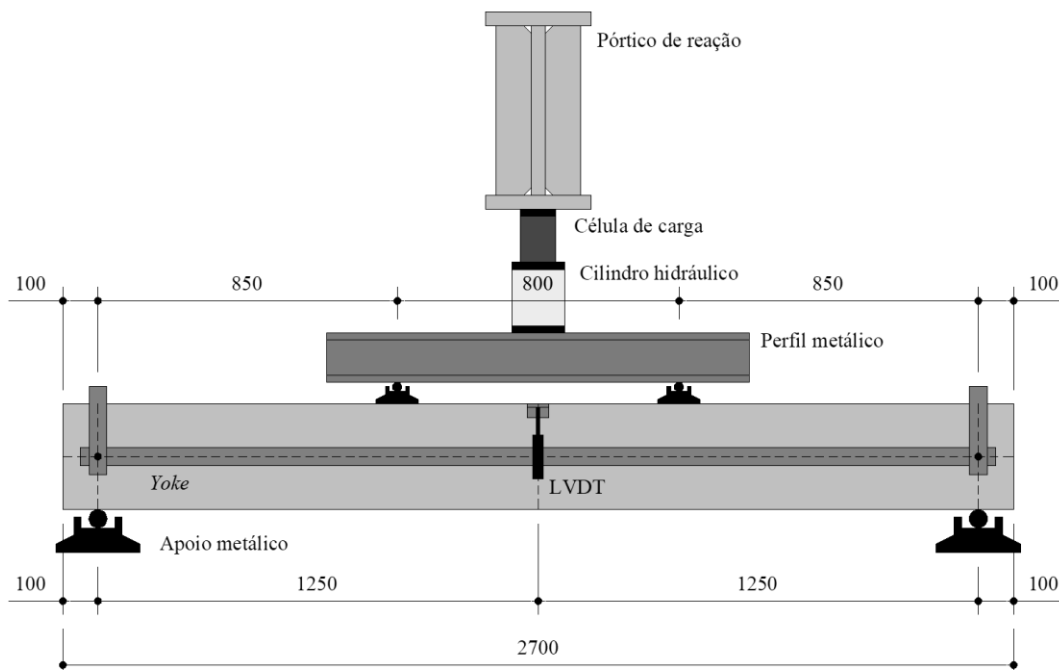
Apresentação esquemática do sistema de ensaio (cotas em mm).
